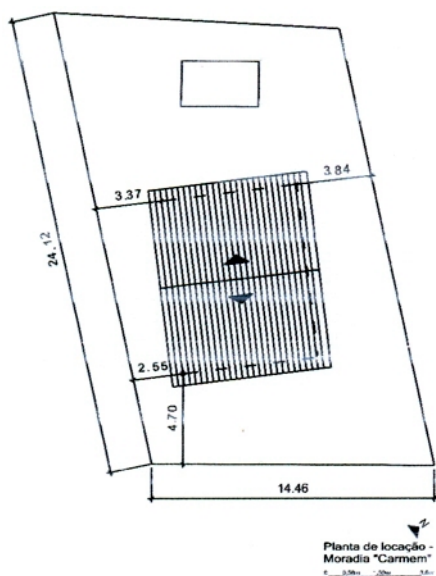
Planta de locação - moradia “Carmem”
